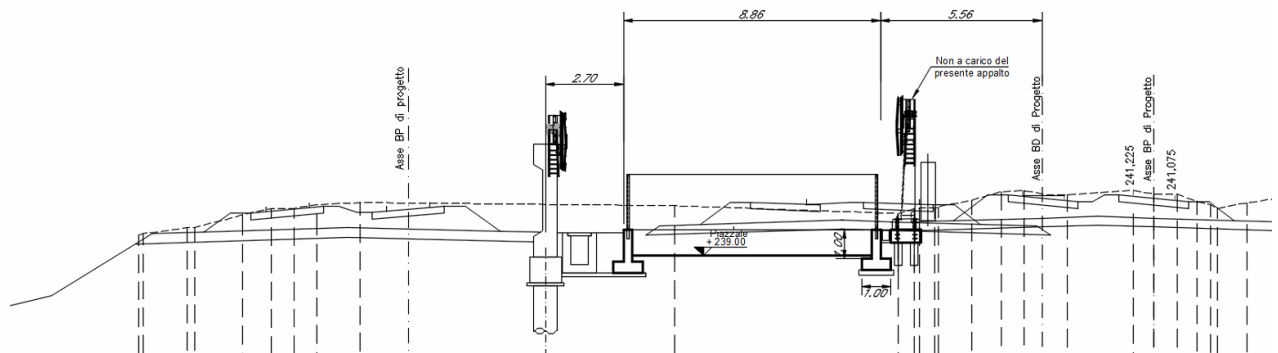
Sezione trasversale piazzale nell'area compresa tra linea BG-PSP e BG-Treviglio
